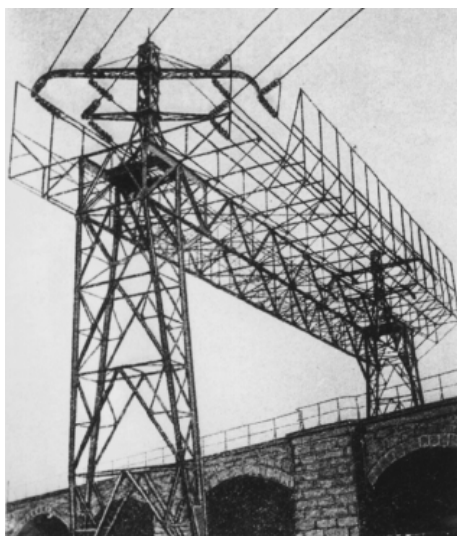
Eisenbahnkreuzung - Schutzgerüst Bild 2: Tragmast
